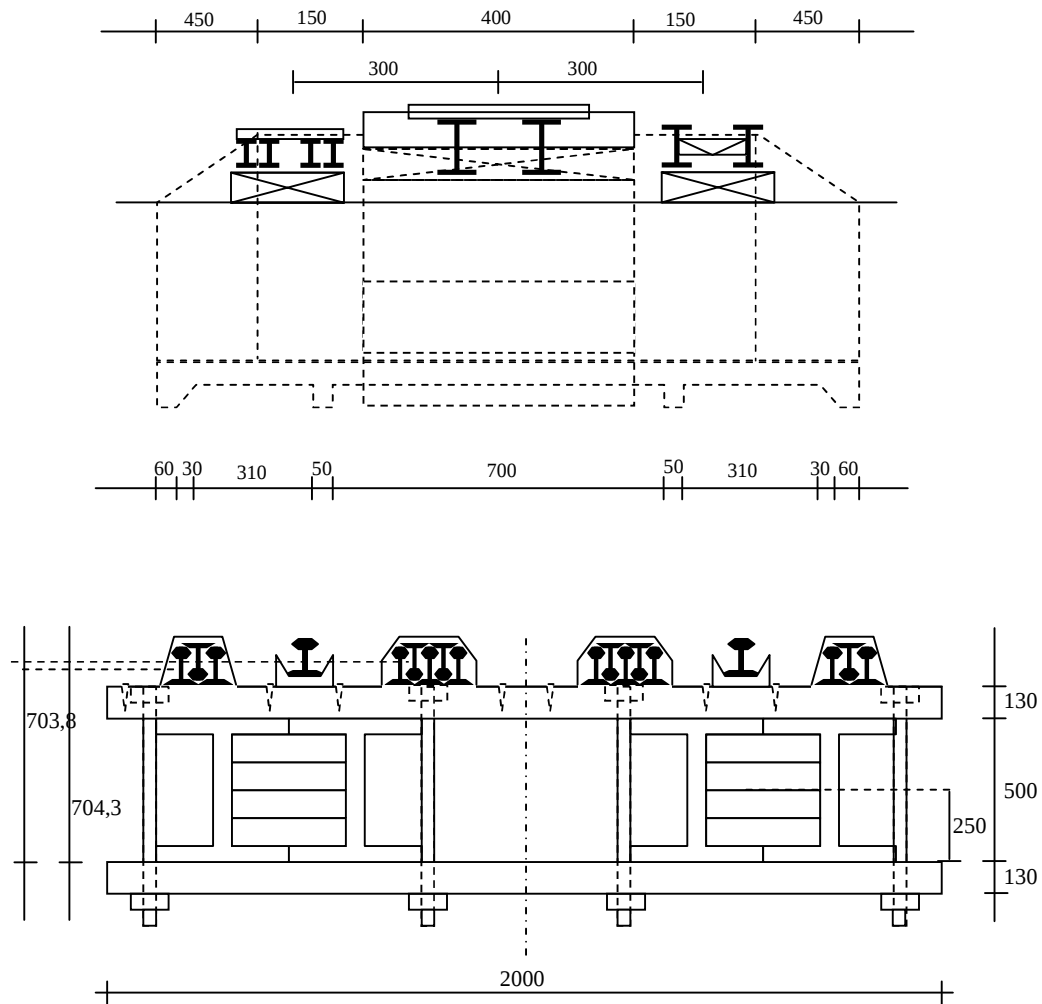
Review Design Konstruksi Jembatan Darurat BH – 22
